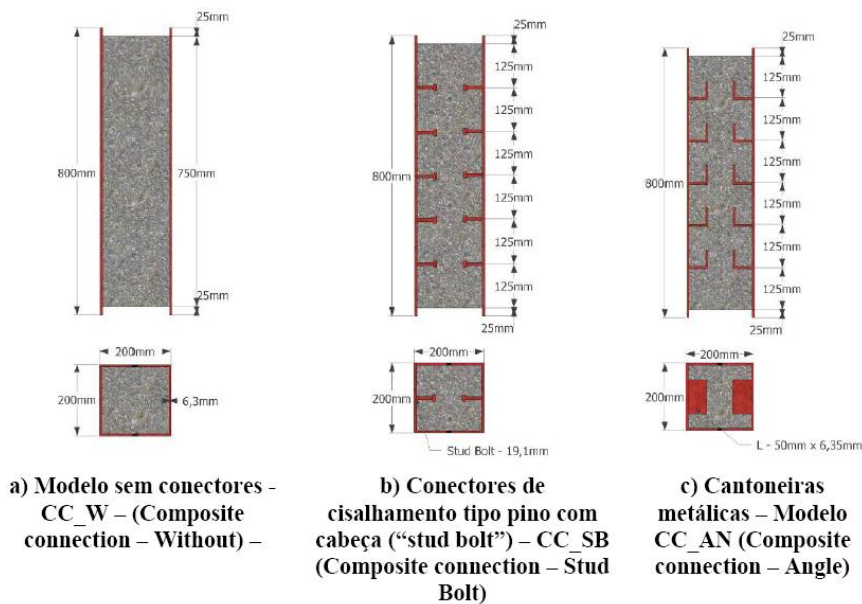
Detalhes e dimensões do pilar misto estudado por Farias (2008)
